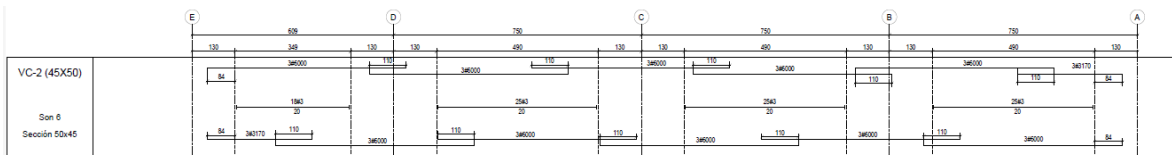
Refuerzo longitudinal de las vigas de cimentación tipo 1
